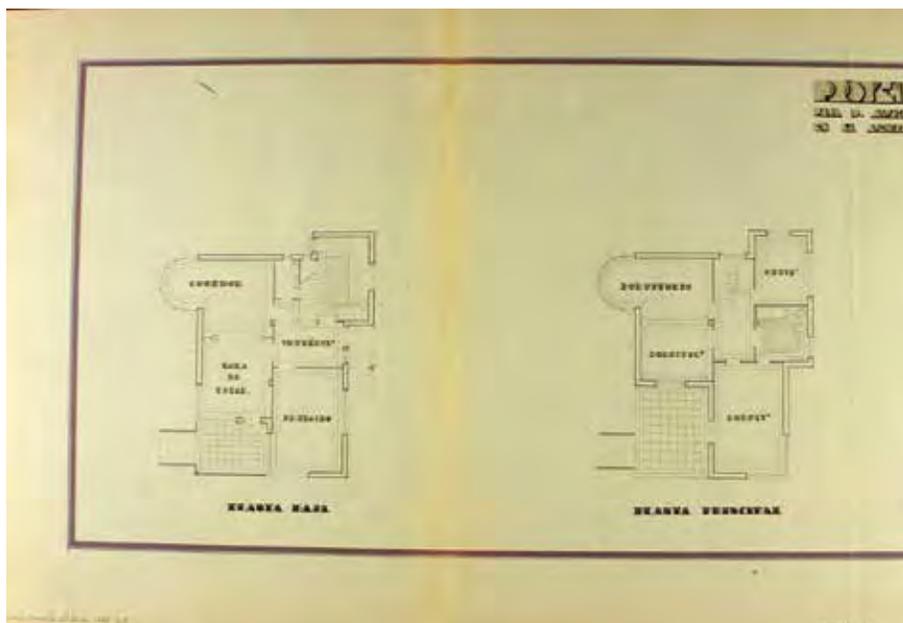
Plano de distribución planta baja y planta primera vivienda de Alfredo Vila (A.H.P. Lu. Concello de Lugo protocolo 0011406-108)
